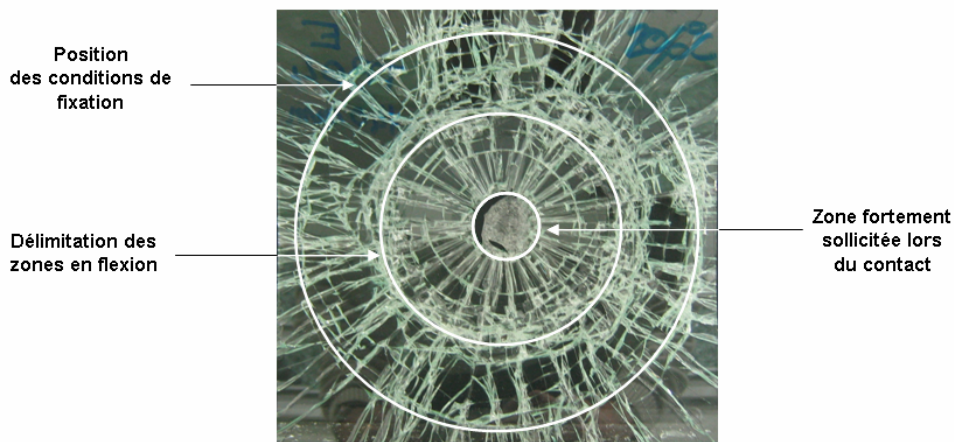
Profil de fissuration d'un vitrage feuilleté 44.2 de dimension 300 mm par 300 mm fixé en appuis simples circulaires ( $\varnothing$  280 mm) lors d'un impact de corps dur sphérique ( $\varnothing$  100 mm) d'une masse de 4 kg à 9,2 m.s<sup>-1</sup>.
